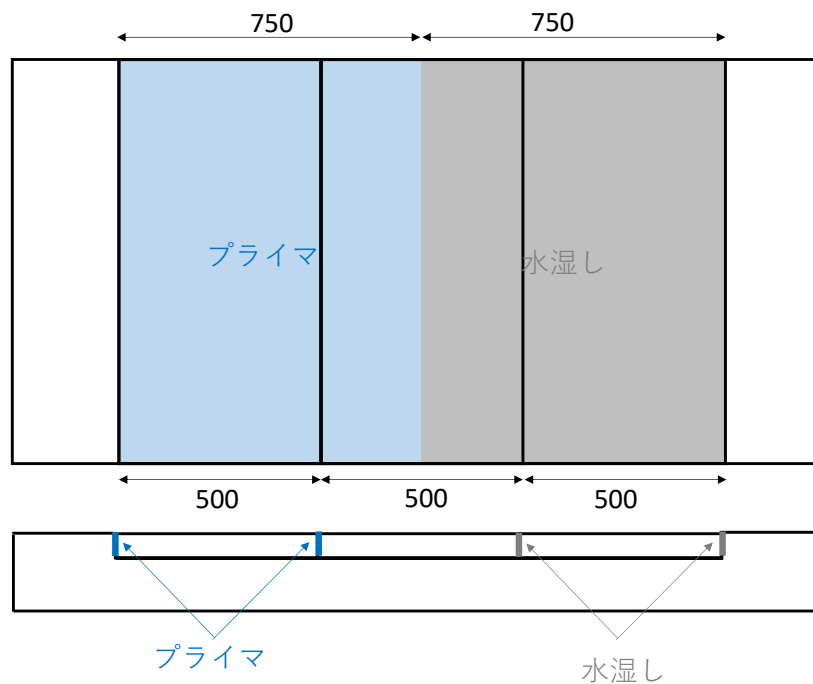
下地コンクリート表面の処理と補修材の施工範囲
